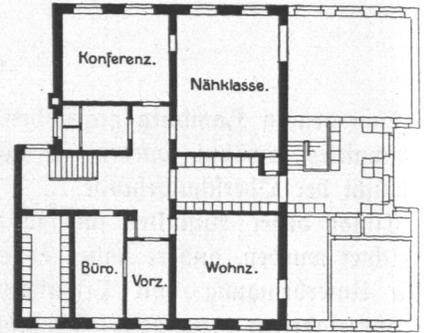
Haushaltungsschule Wallstraße, Obergeschoss.
